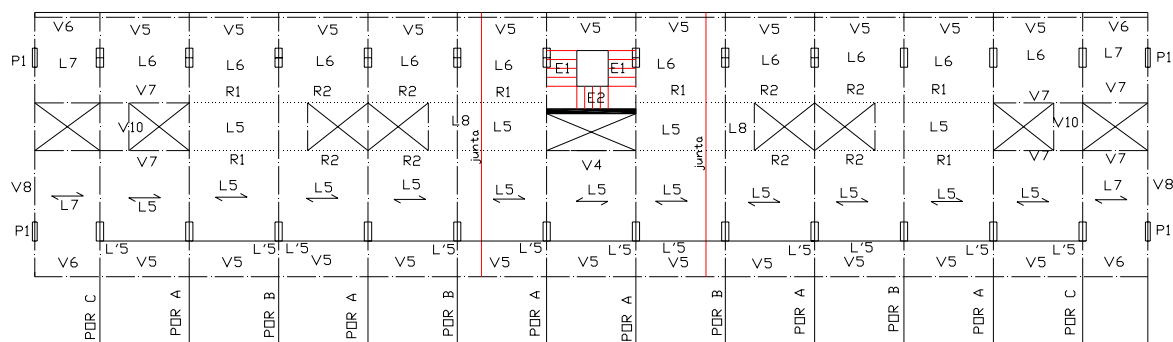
Planta estrutural dos andares superiores (2º, 4º, 6º, 8º)
